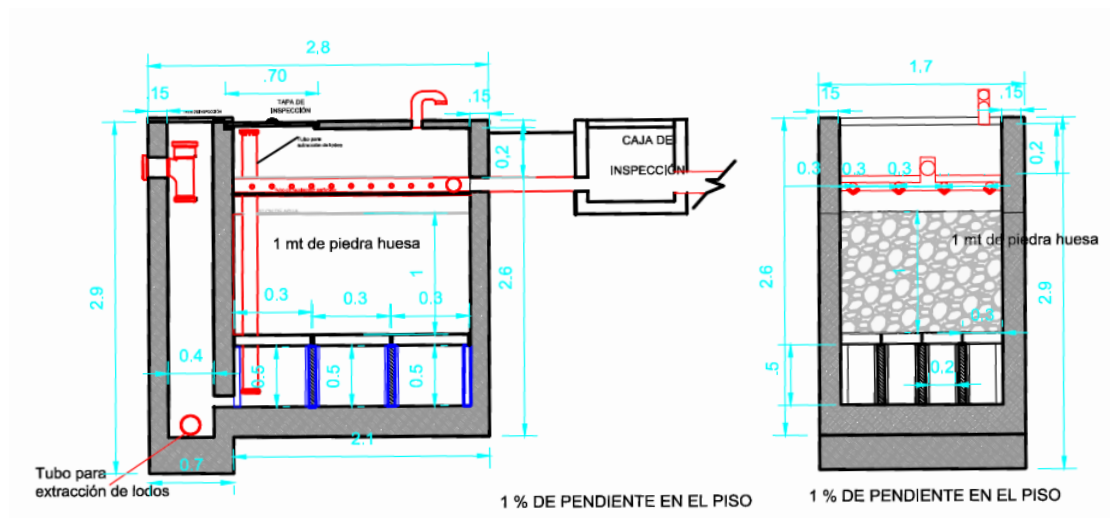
Vista del corte longitudinal y el corte transversal del FAFA planteado
